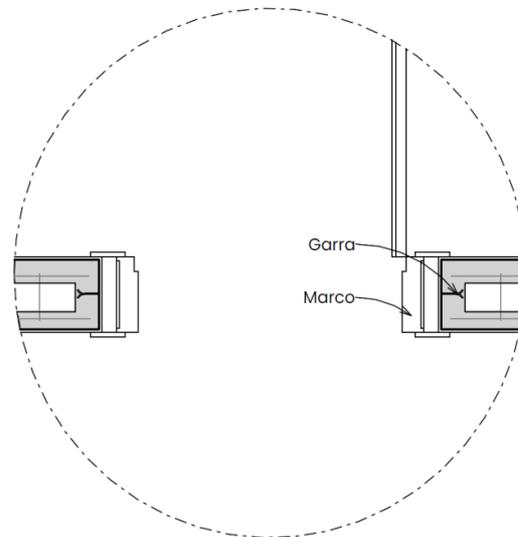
Detalle genérico de anclaje de carpintería para ventana
